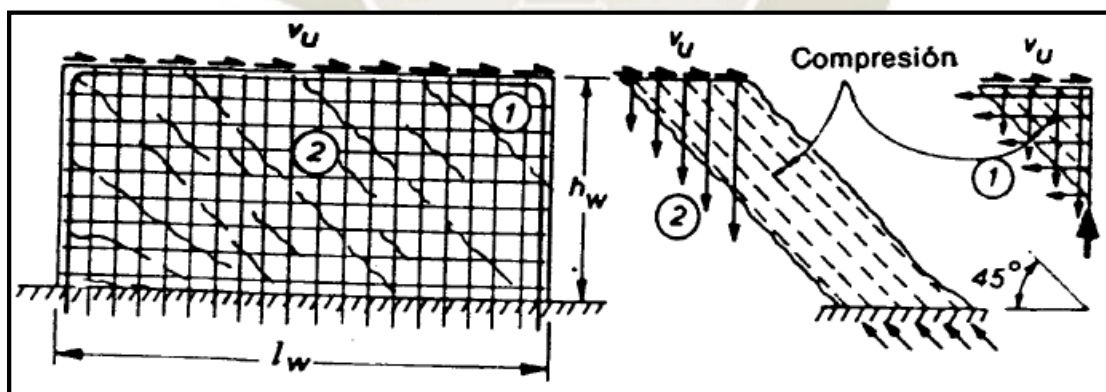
Distribución de esfuerzo cortante en muros bajos (Park & Paulay, 1988)
